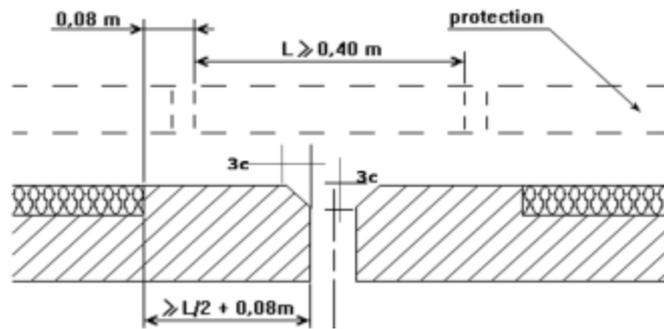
Terrasses accessibles aux piétons et séjour - Dimensionnement de la retenue en béton
